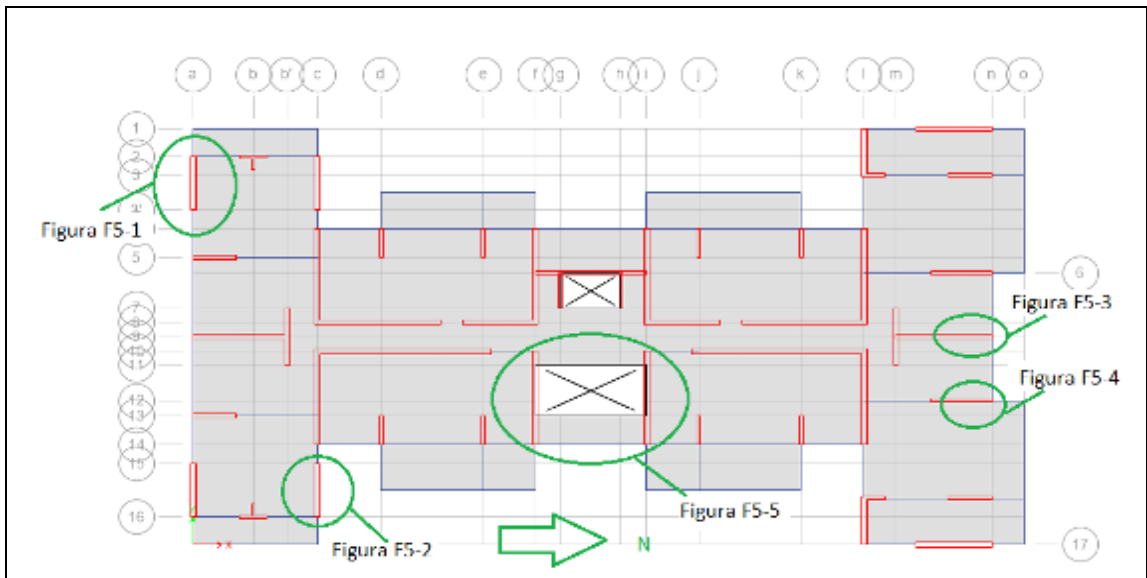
Edificio F5, planta piso 1, se indican los elementos dañados
